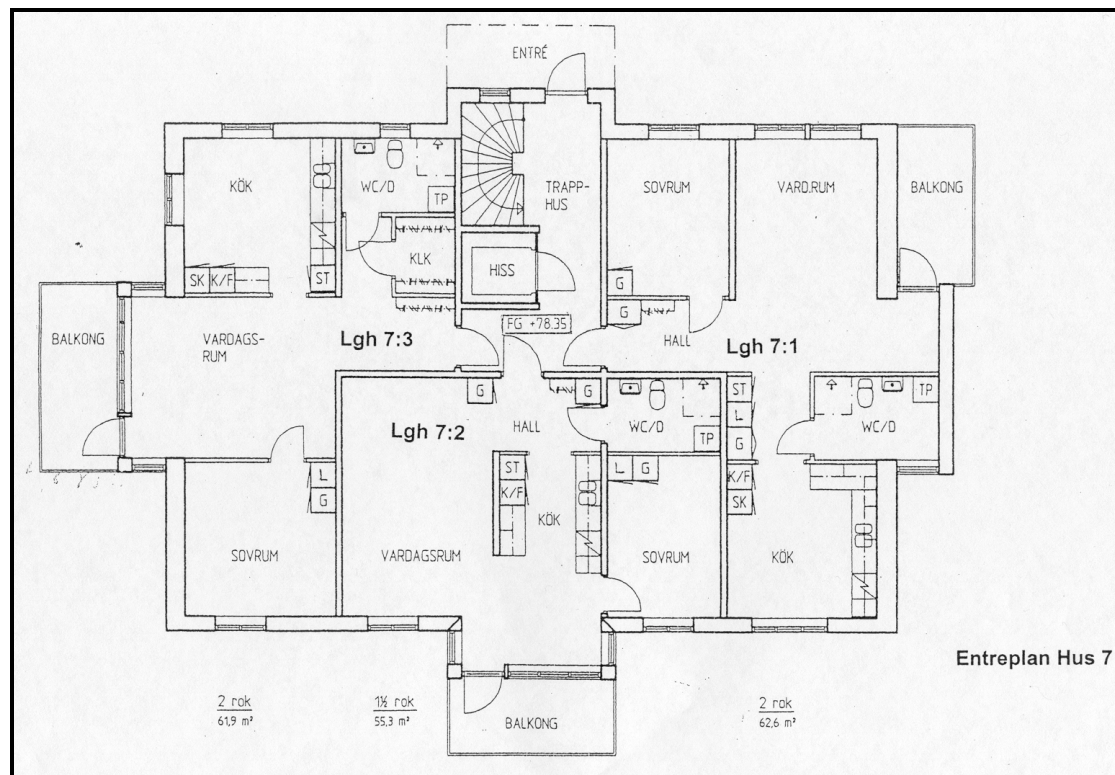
Typvåningsplan Gammfällan, lägenhetsstorlek, utrymningsvägar.
